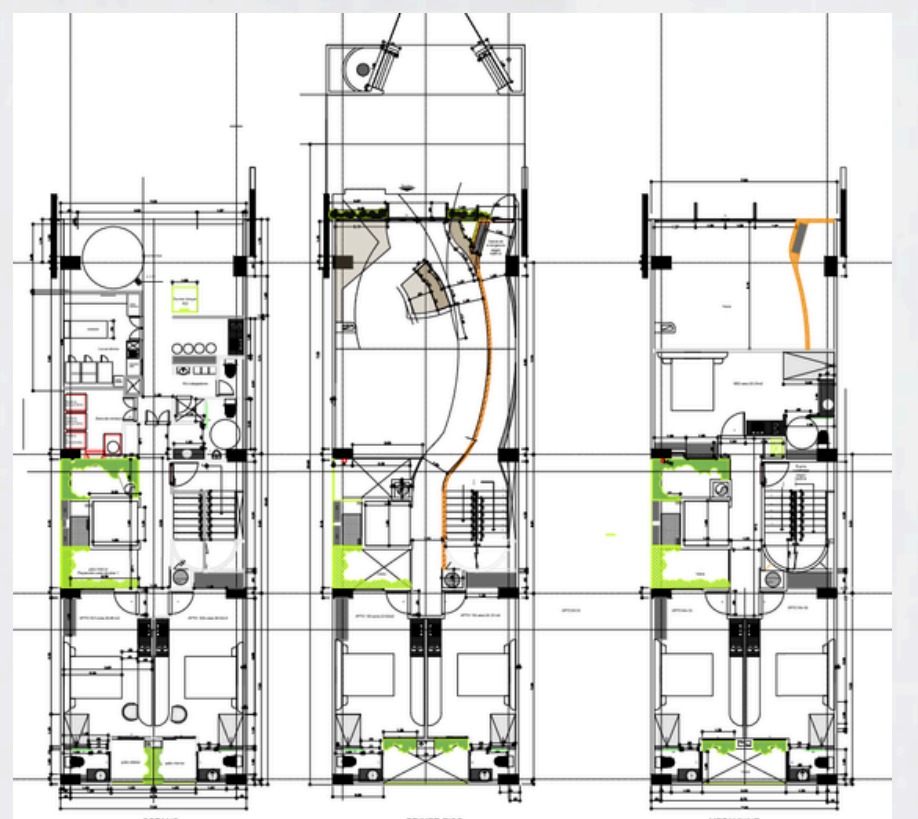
Planimetría Arquitectónica Obra Livvo Living
